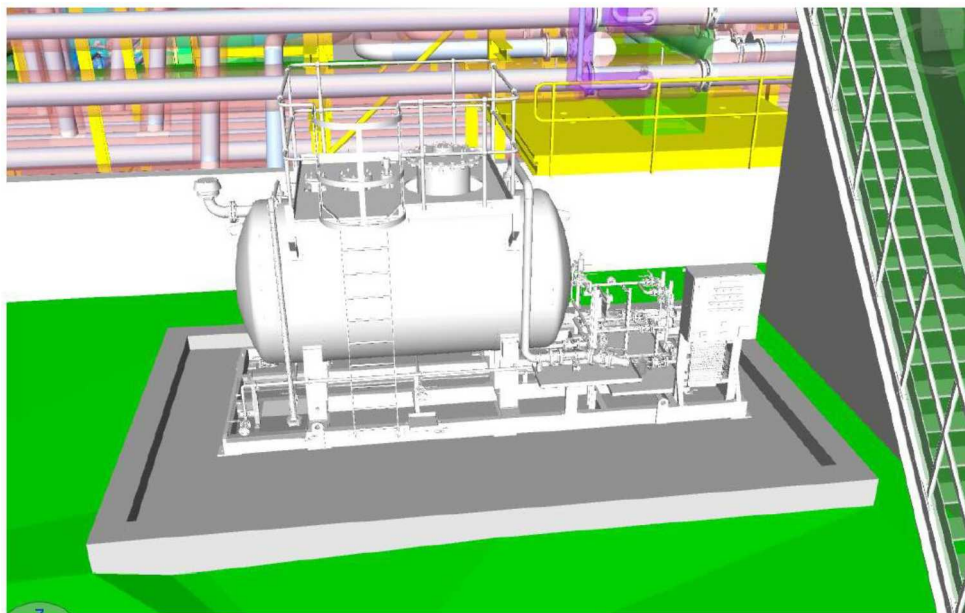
Udformning af opsamlingskapacitet ved Berth Loading Facility.
